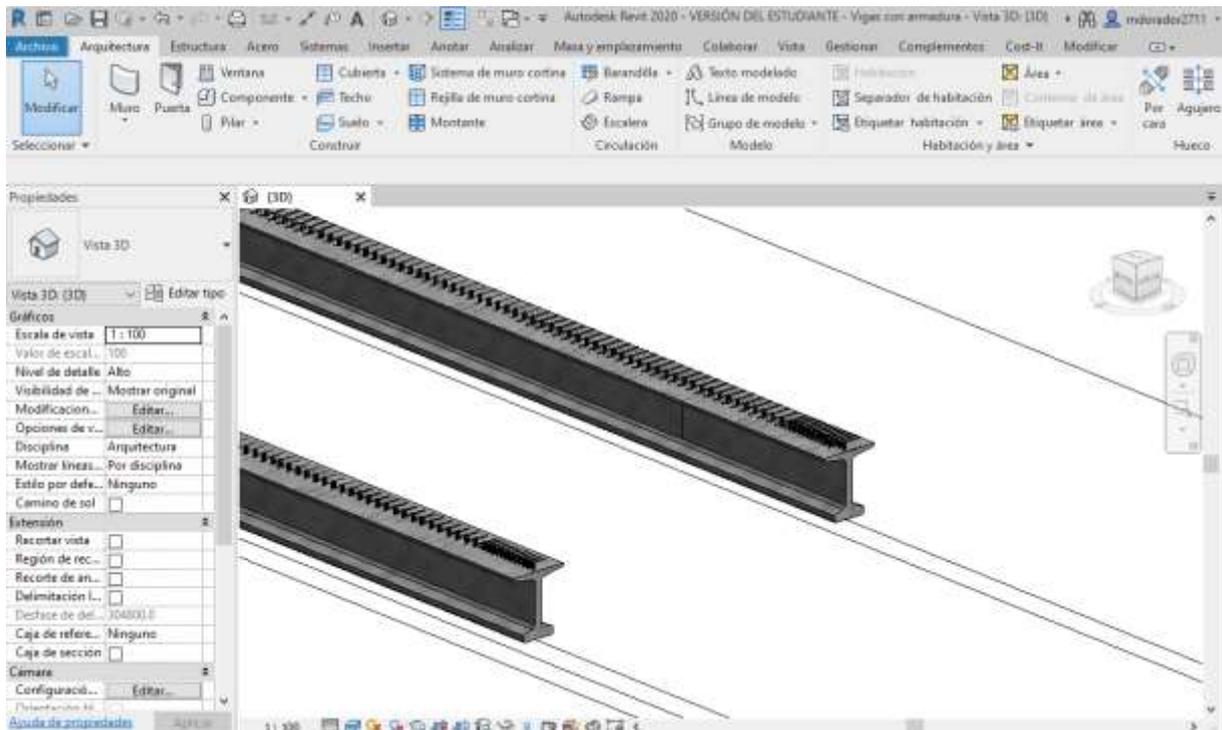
Vigas creadas en un archivo de Revit® (.rvt). Fuente: El. prop.
